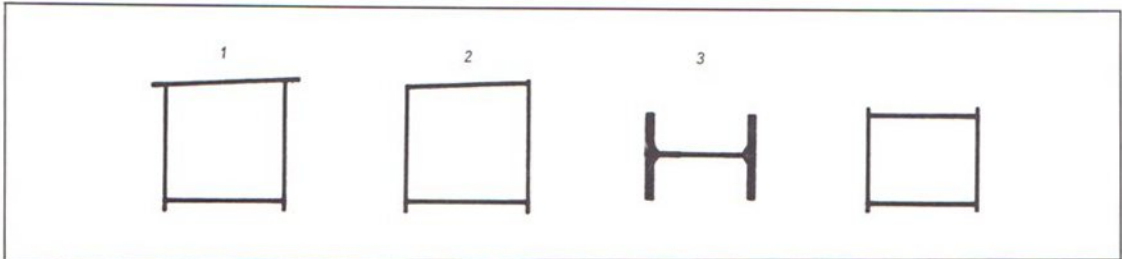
Stabquerschnitte bei geschweißten Gurten und Streben.
